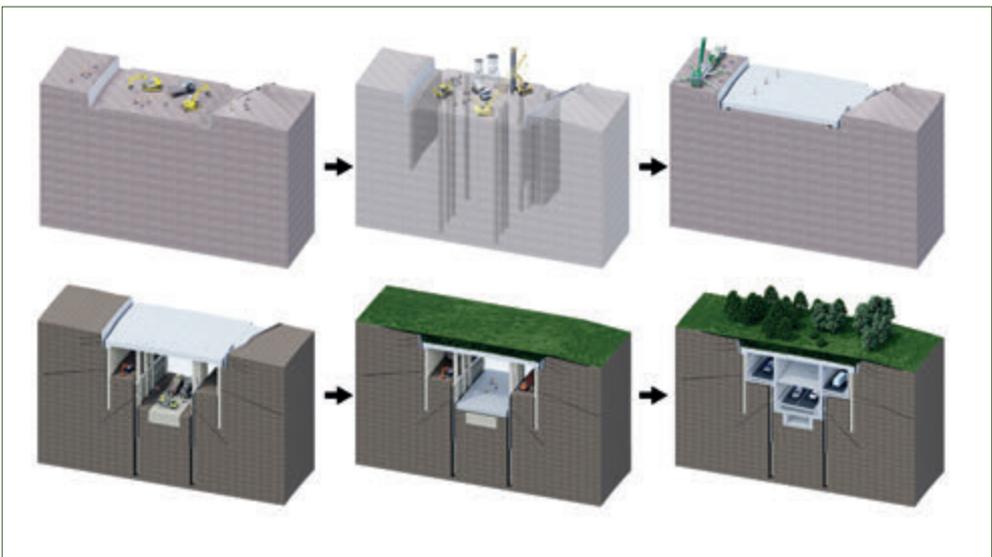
Galleria Artificiale UDEC – Metodo Top Down – Schema disposizione Conci
